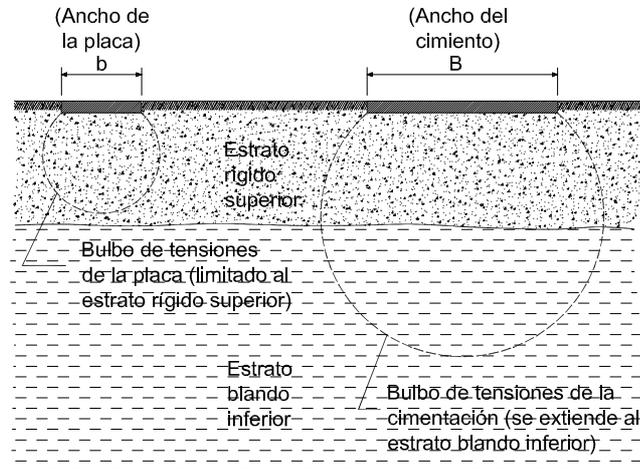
Limitaciones del ensayo de carga con placa en terrenos estratificados
